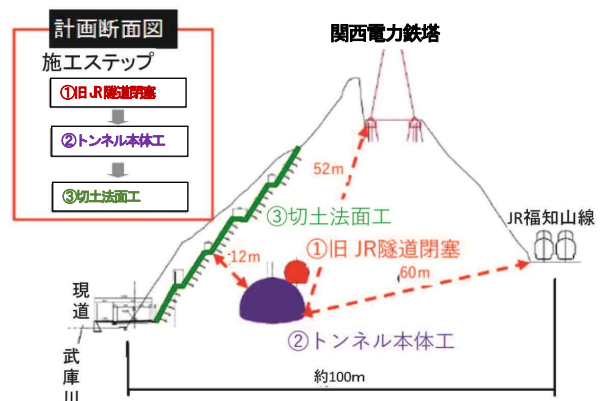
計画断面図 (No. 421+0.4)¹⁾一部修正
